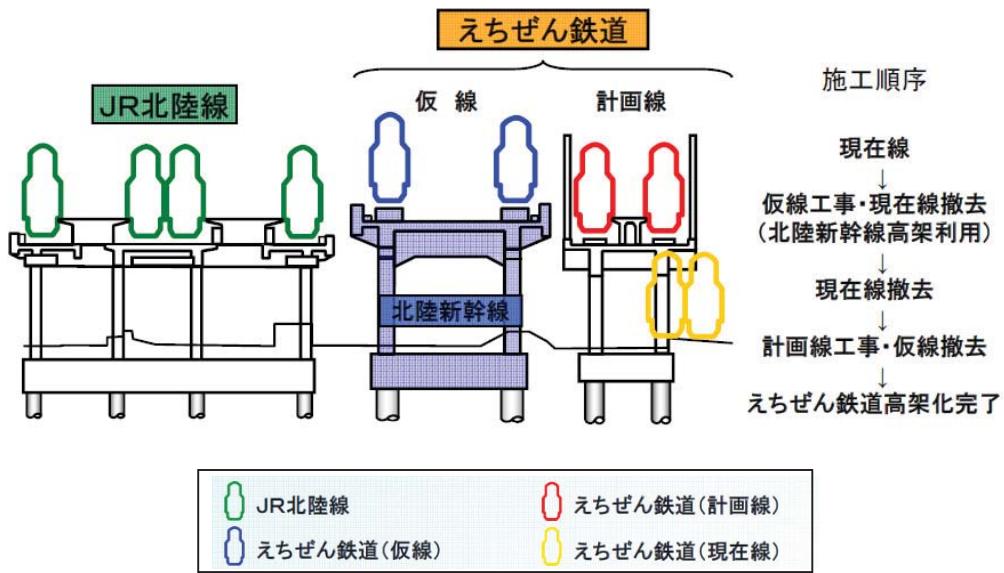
えちぜん鉄道高架化工事施工順序概要図
